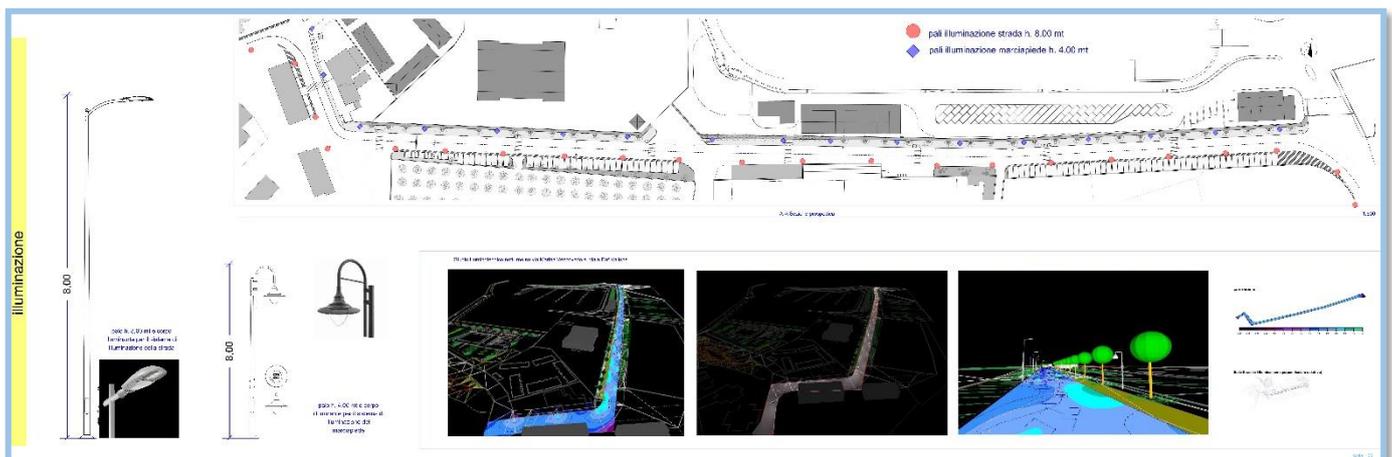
Planimetria e dettagli impianto di illuminazione via marina Vescovalo
